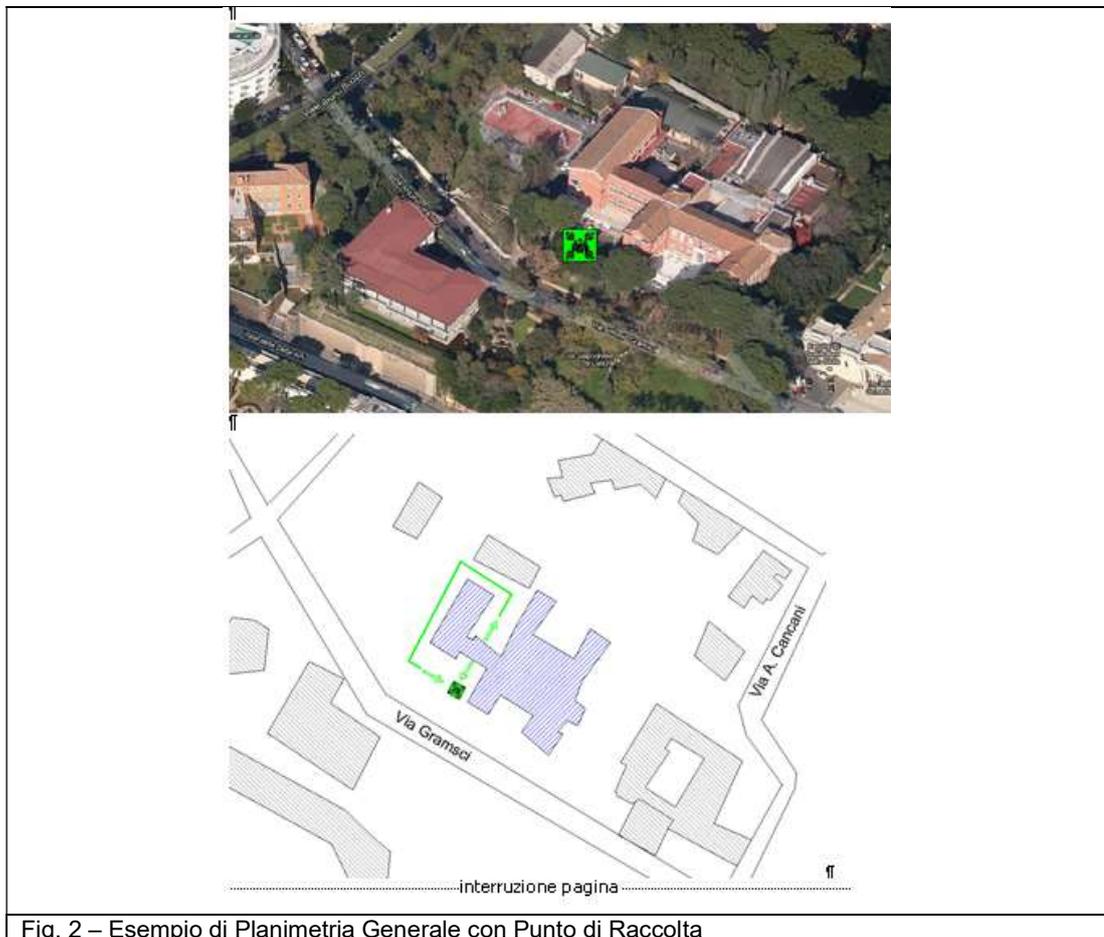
Esempio di Planimetria Generale con Punto di Raccolta
